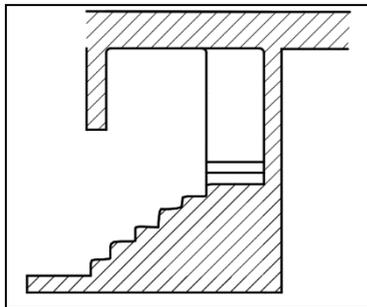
escaiers sur blockage de pierres. source: fait par l'auteur
